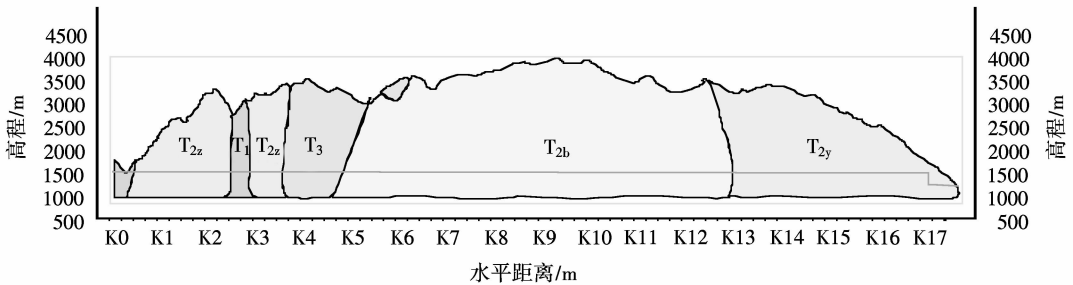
锦屏二级水电站施工排水洞工程地质纵剖面图
